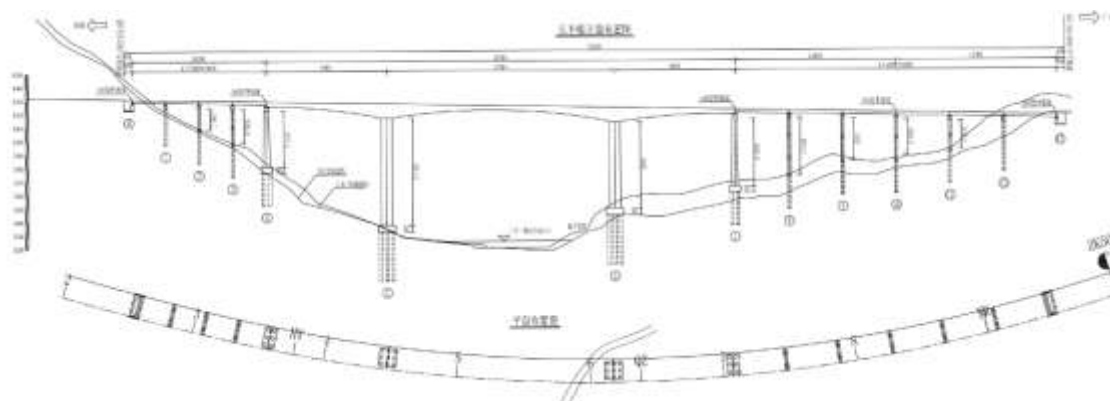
南河一号特大桥（左幅）立面布置图
